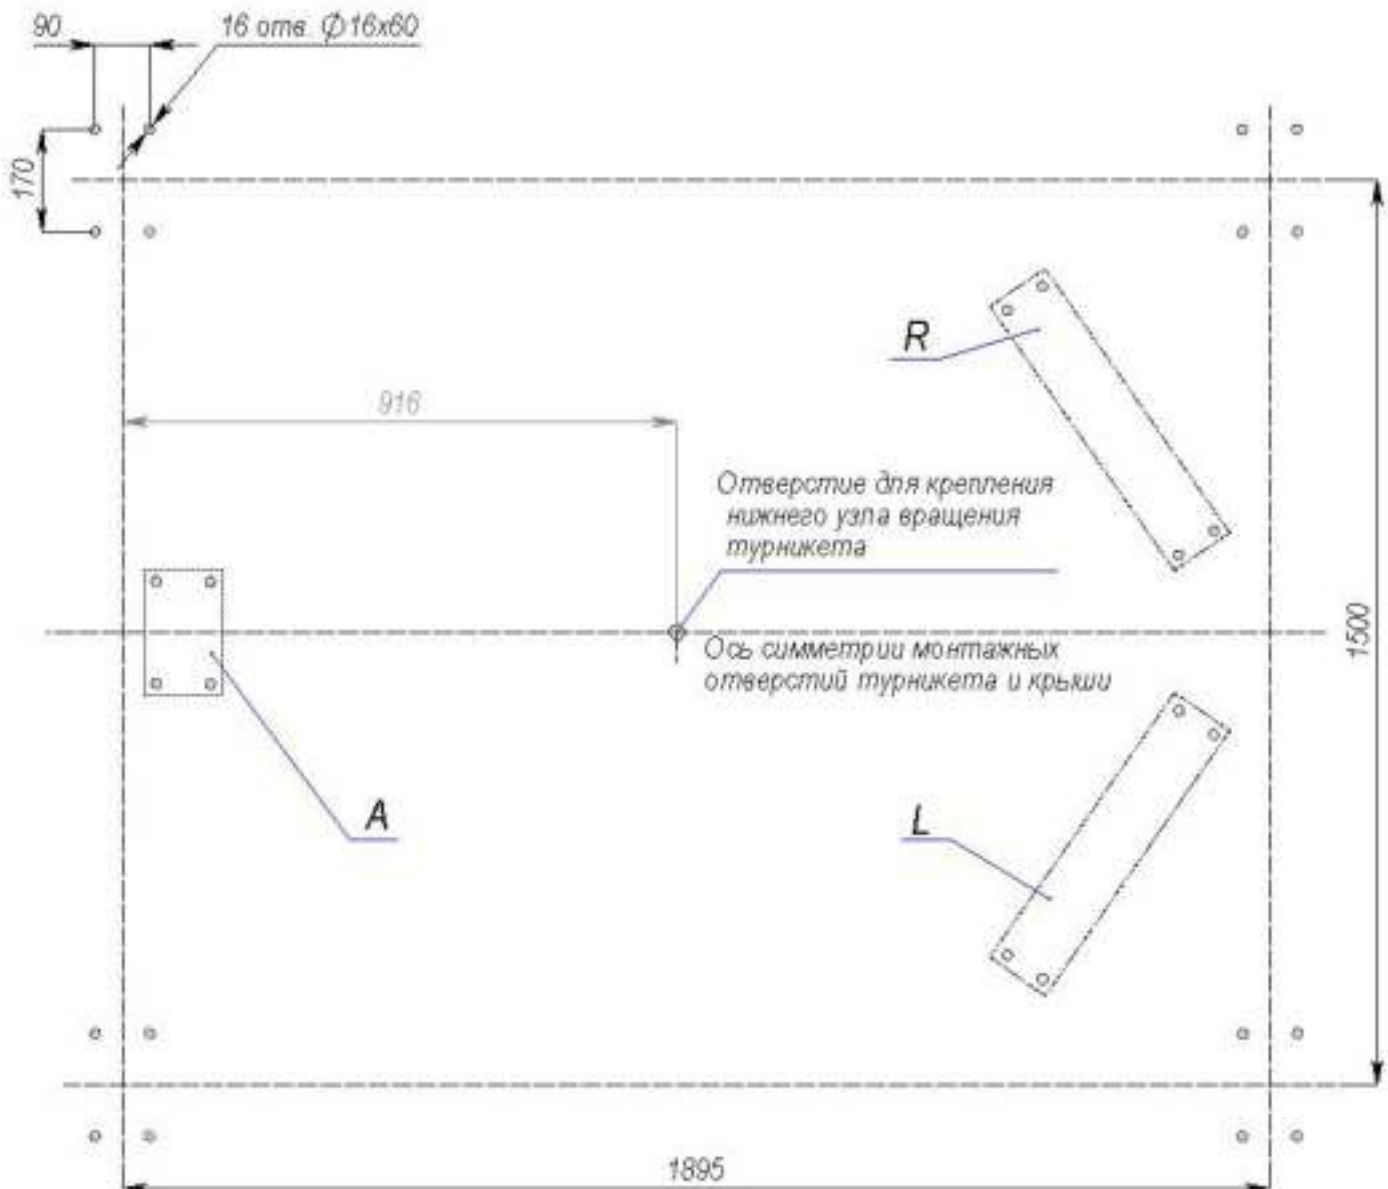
Схема разметки отверстий для крепления стоек (3) крыши относительно отверстий для крепления турникета:
